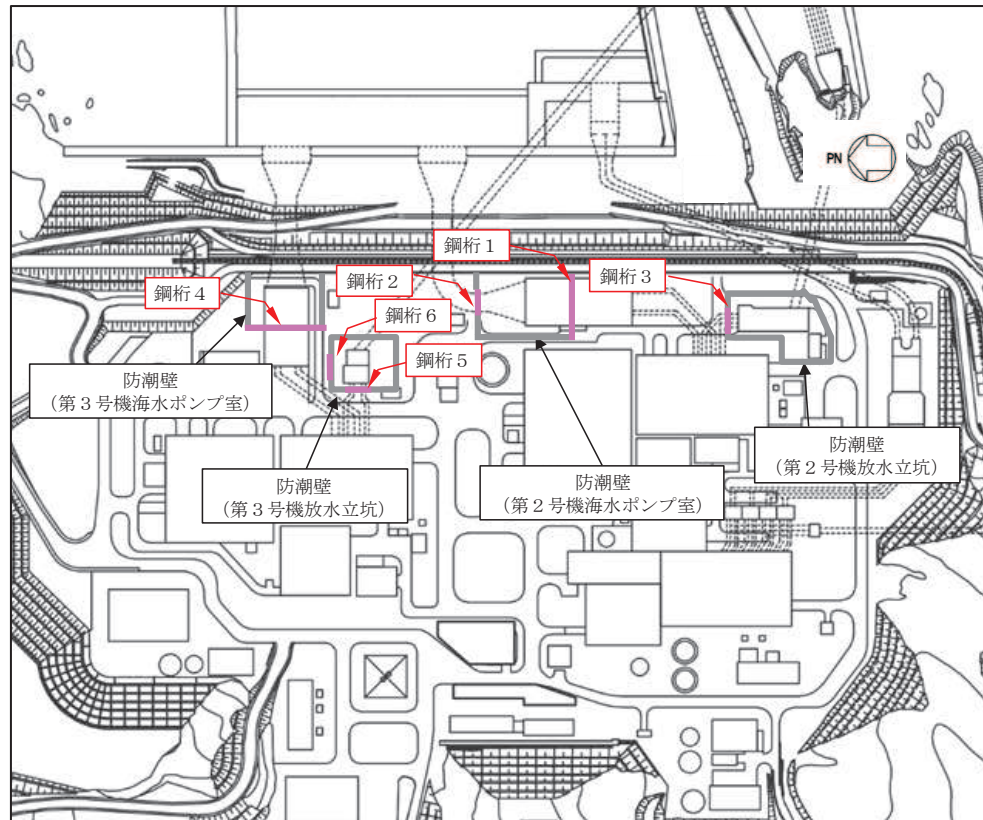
鋼製遮水壁(鋼桁)の平面位置図
